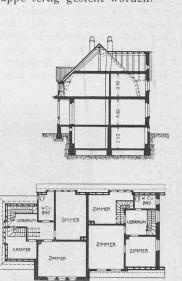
Grundrisse und Schnitt des Einfamilienhauses. - Masstab 1:400. - Abb. 7. Grundrisse und Schnitt des Doppelhauses.
